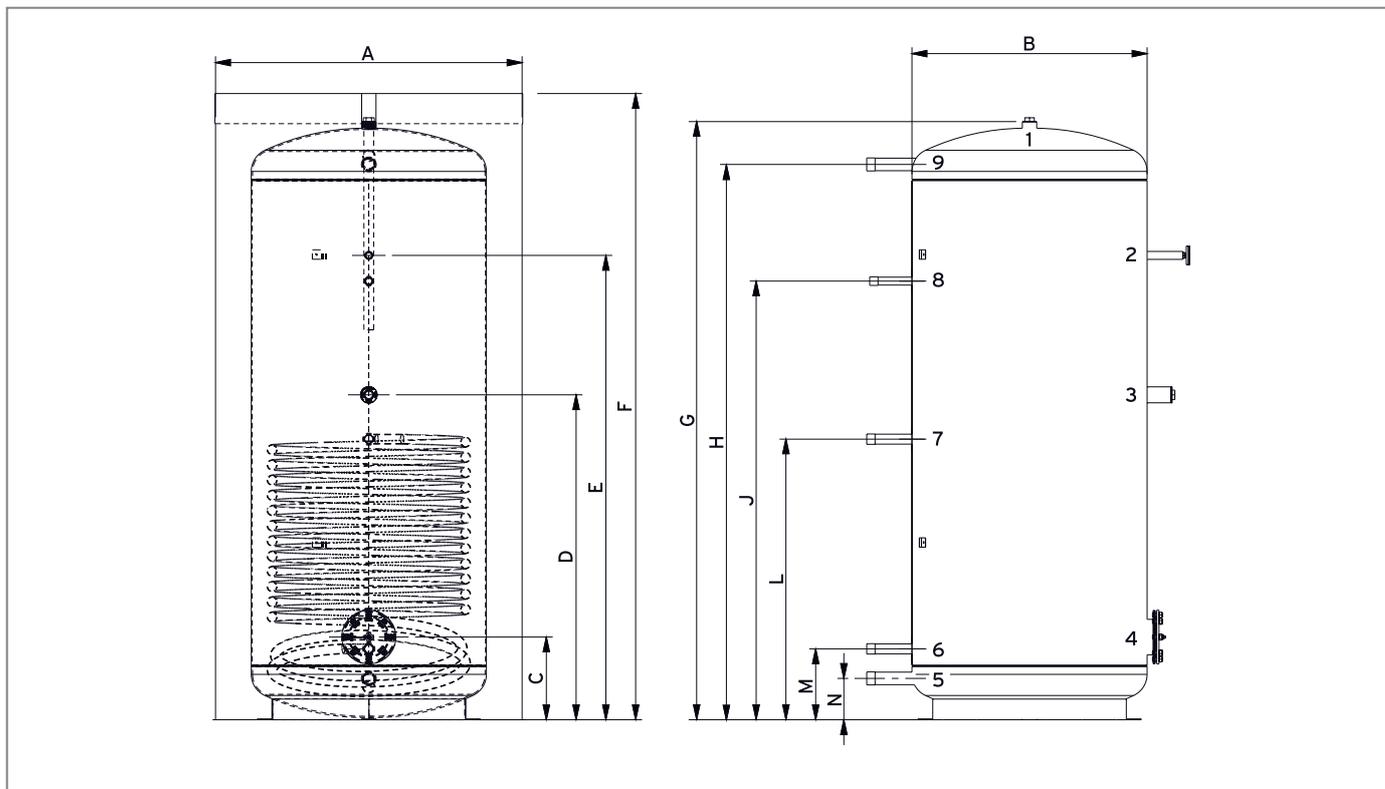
Dimensioni VIH R e dimensioni degli attacchi
